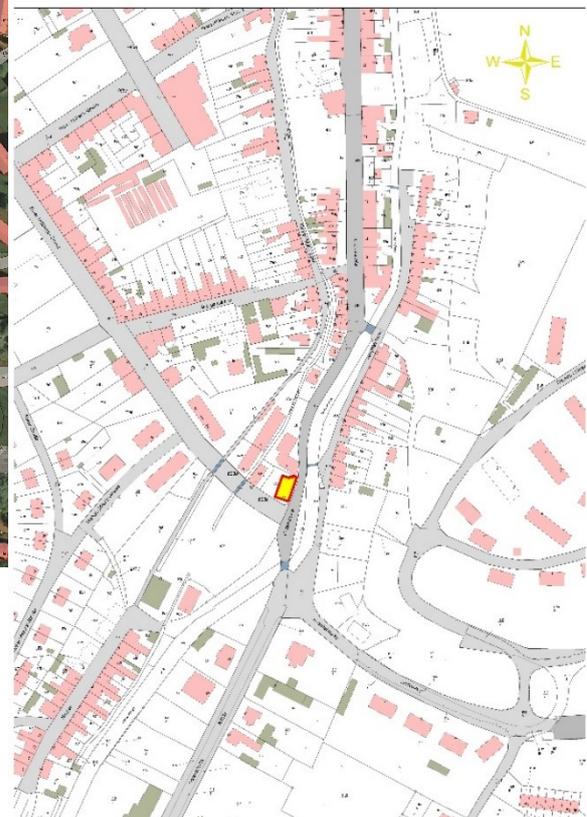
Lageplan Ernst-Thälmann-Straße 41 –
